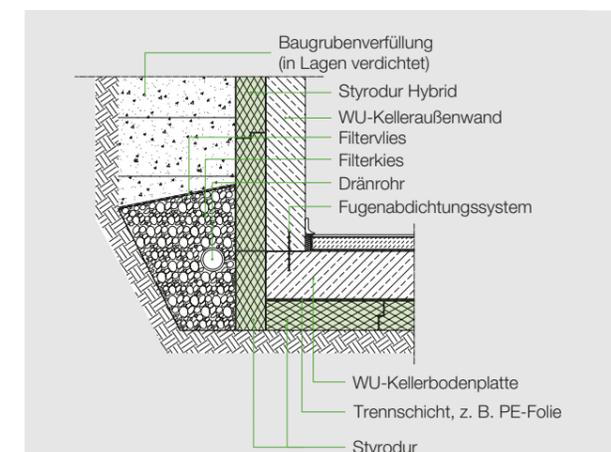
Aufbau einer Perimeterdämmung, kombiniert mit einer Dränung
